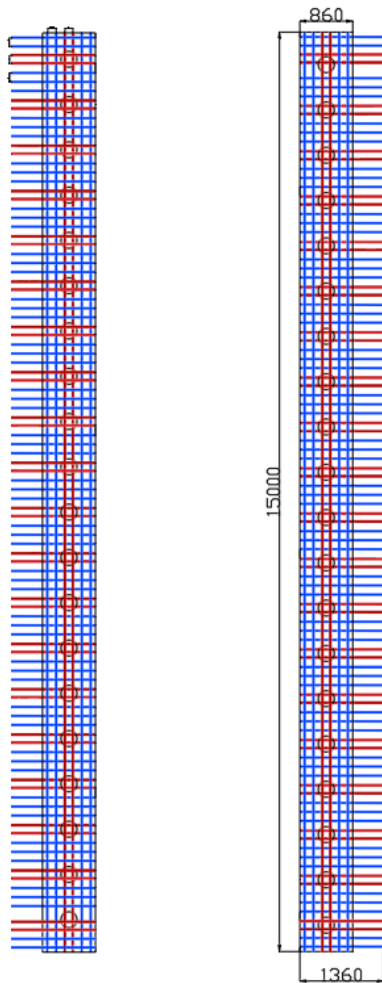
Armaduras completas de la Pila 2 Lado Largo
